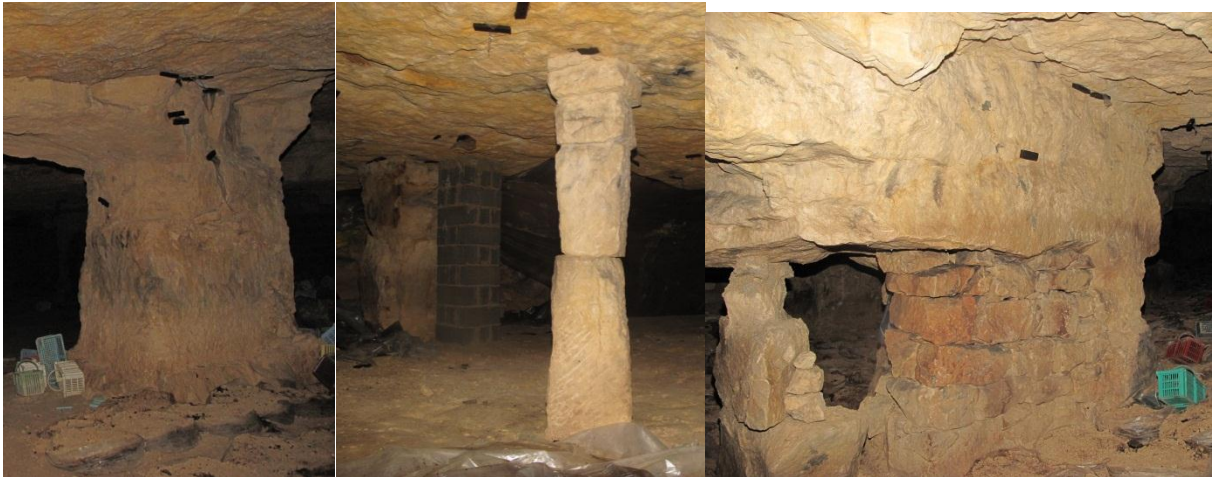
Différents types de piliers rencontrés dans la carrière d'Aubigny : pilier tourné (à gauche), pilier à bras et pilier maçonné (au centre), pilier reconstitué (à droite)
